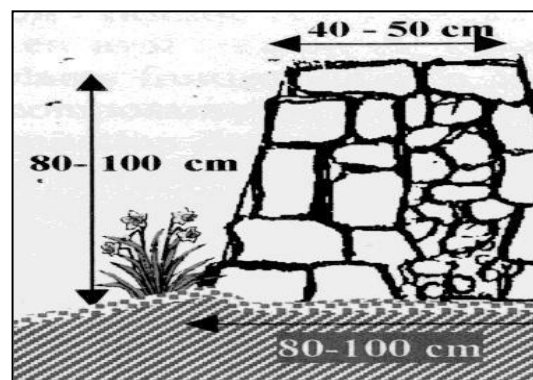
Murette en pierre sèche (HCEFLD, 2014).
